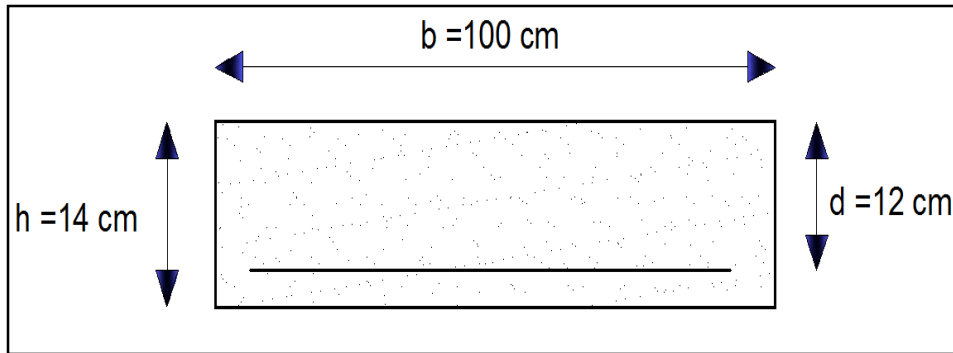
Coupe d'une bonde d'1 mètre de l'escalier.
